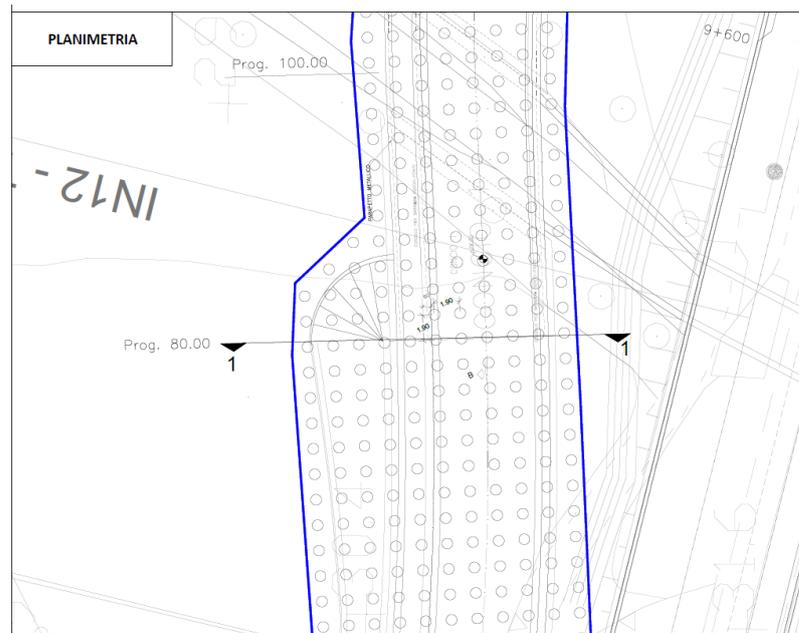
Sezione rappresentativa tratta IV03 – rilevato 1 - planimetria
